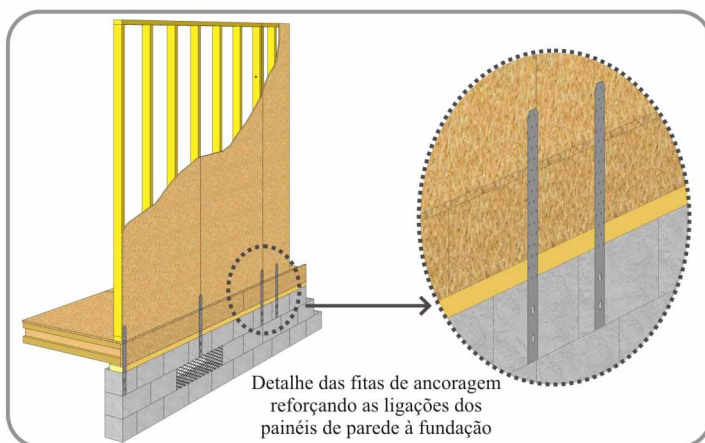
Fitas de ancoragem reforçando ligação dos painéis de parede à fundação
